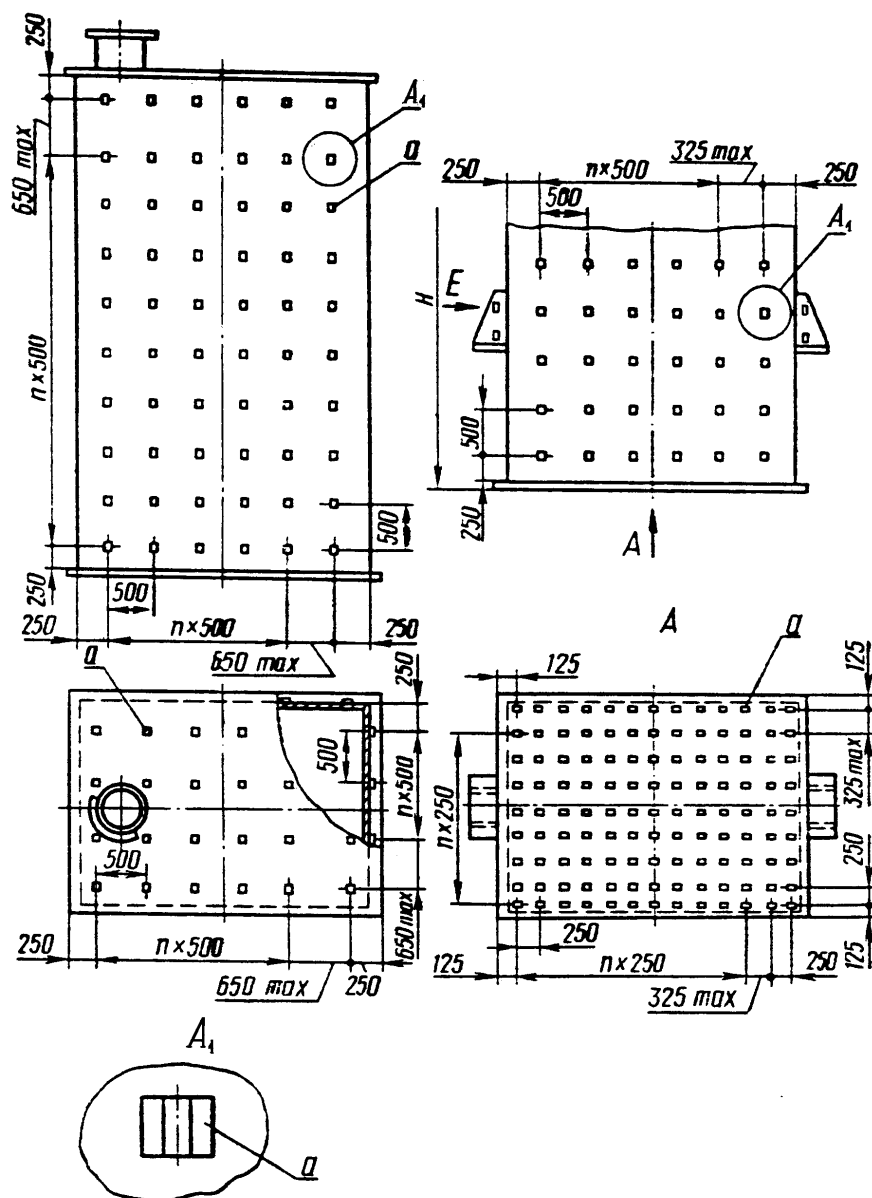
Схема розміщення приварних деталей для кріплення теплової ізоляції на апаратах прямокутного поперечного перерізу: «а» – приварна деталь
